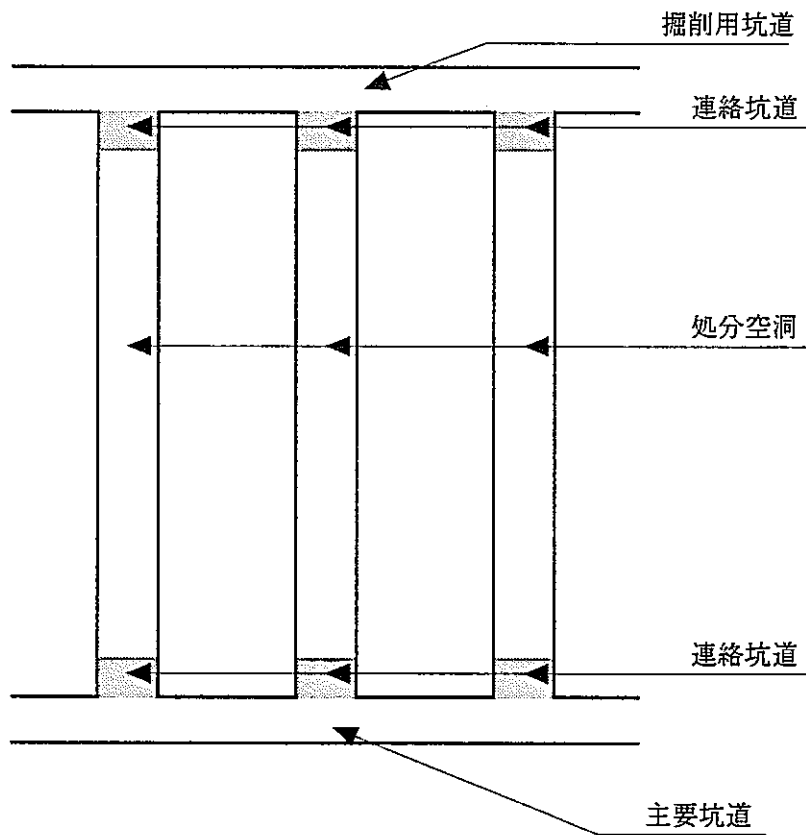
小断面岩洞方式 連絡坑道断面図
